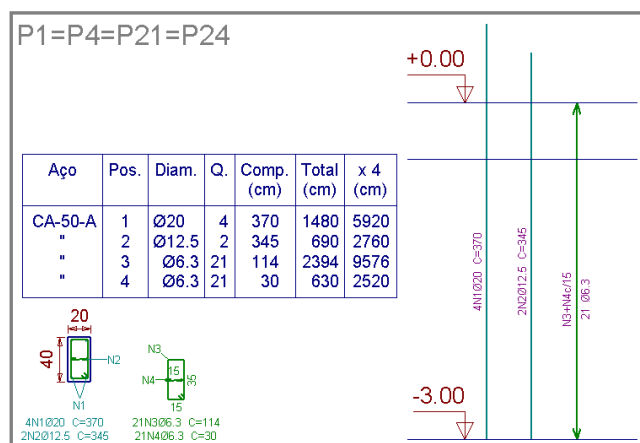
Detalhamento do P1 entre a fundação e o 1º Pav. – CYPECAD 2008 [5].
